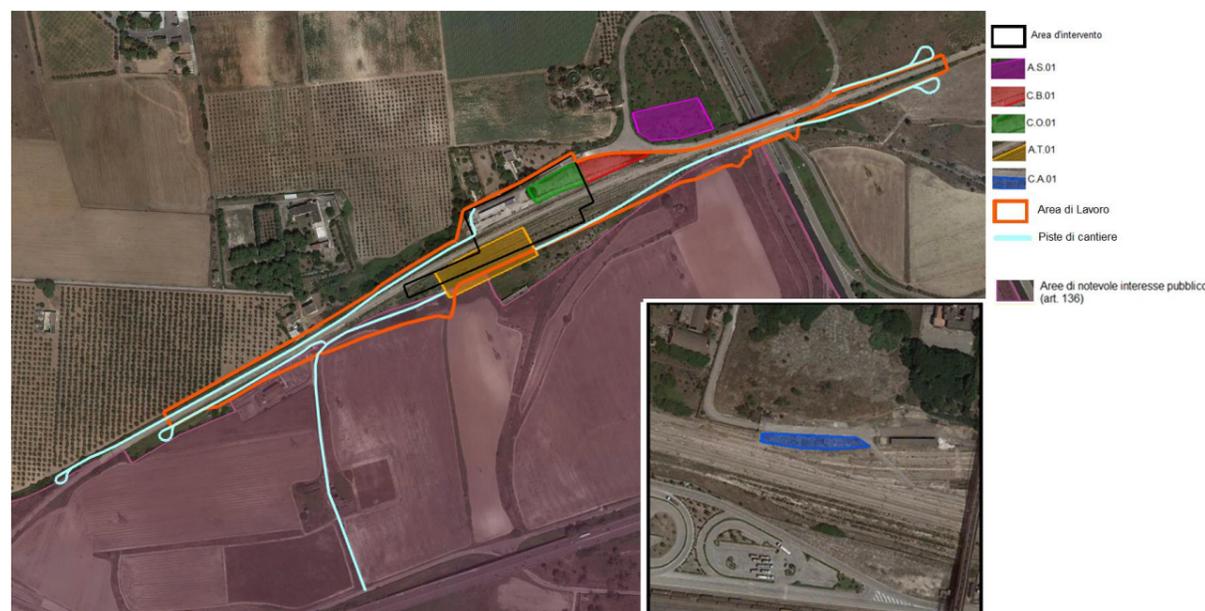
Localizzazione dell'area d'intervento e delle aree di cantiere rispetto il vincolo
